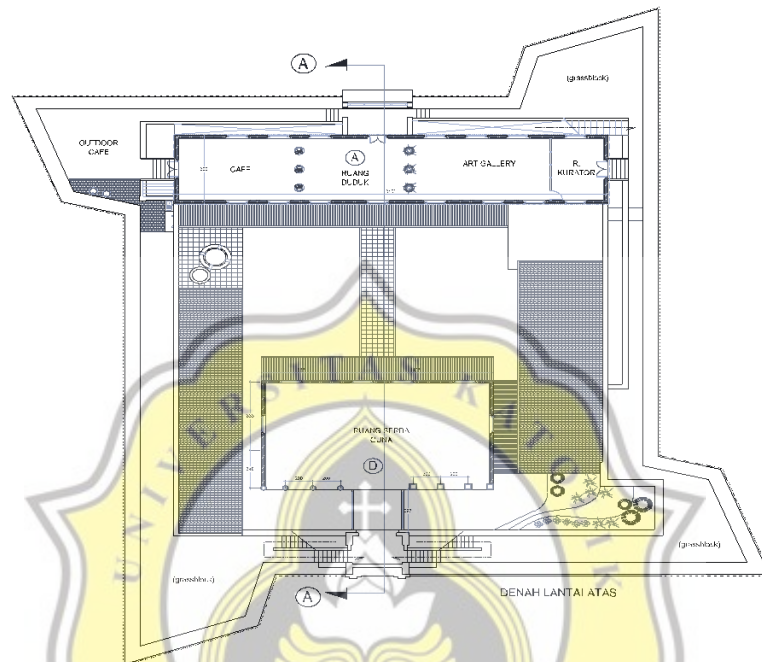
Rencana Siteplan Benteng Willem II Ungaran
